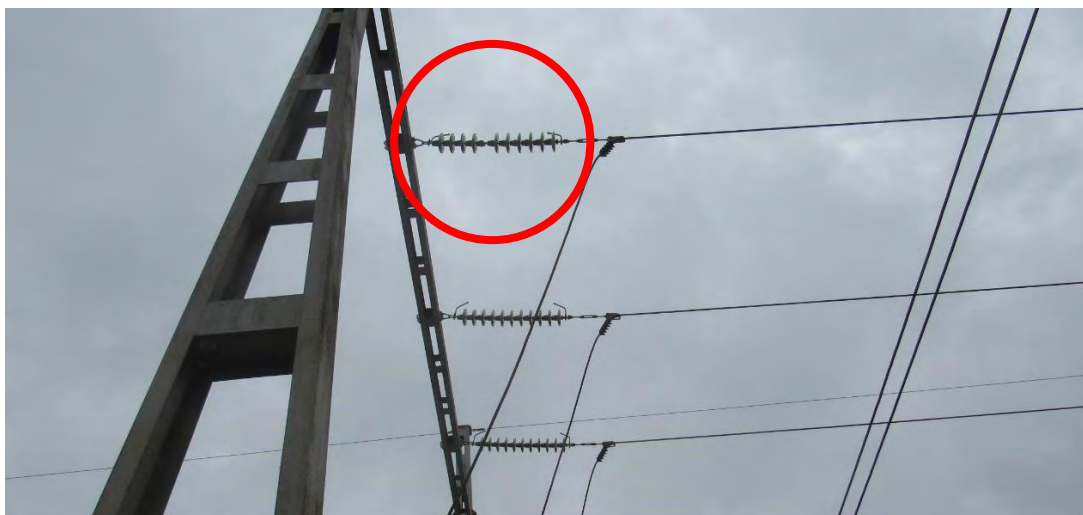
Pórtico de subestação de distribuição com isolador quebrado na cadeia de isoladores
